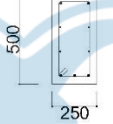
Detail penulangan balok lantai 2 dan 3 as 2-6
